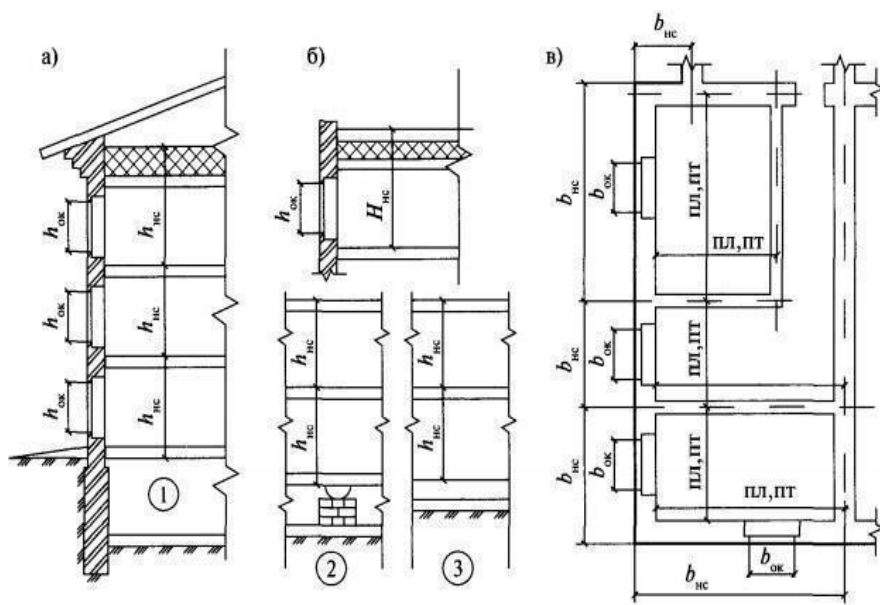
Правила обмера ограждающих конструкций: а – разрез здания с чердачным перекрытием; б – разрез здания с совмещенным перекрытием; в – план здания; 1 – пол над подвалом; 2 – пол на лагах; 3 – пол на грунте.
